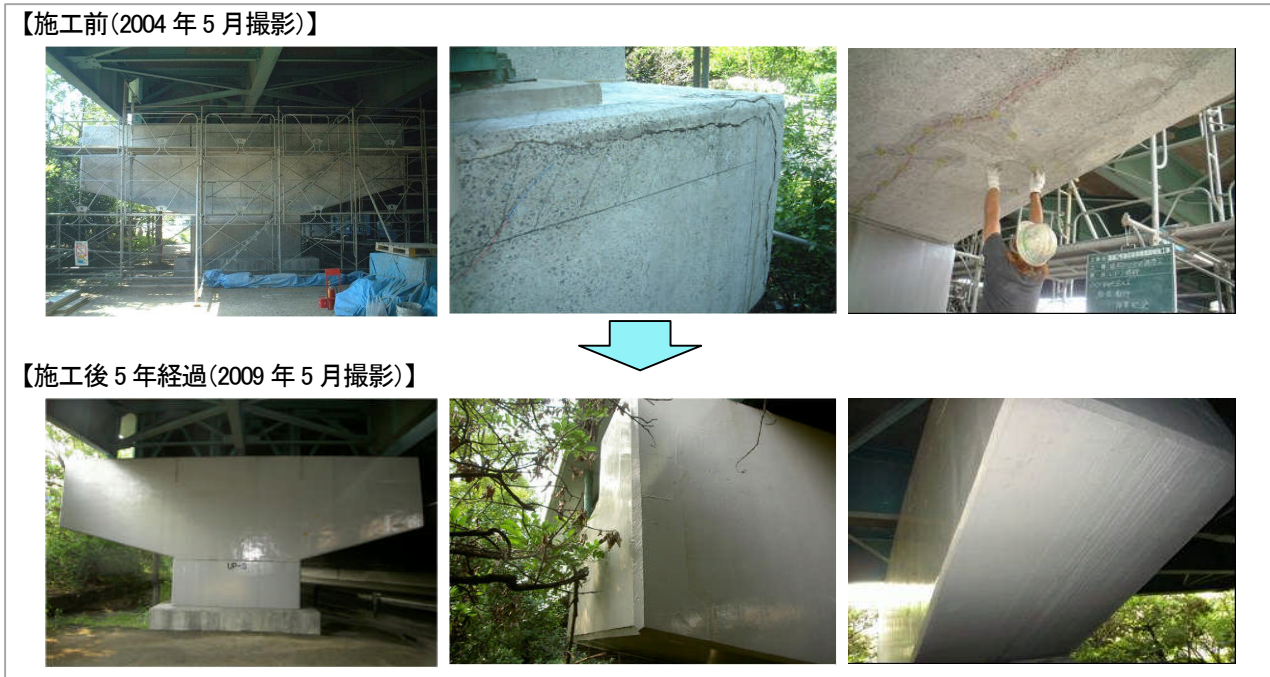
海田高架橋橋脚 施工前状況と施工後5年経過時の状況
